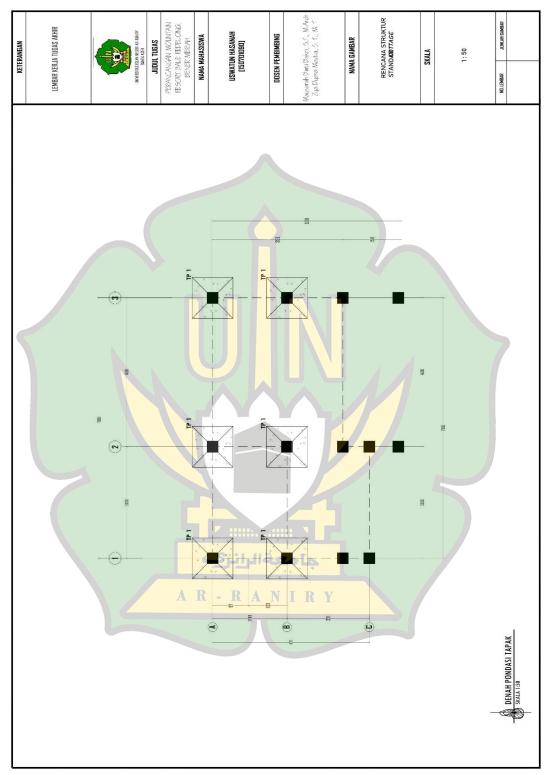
Rencana Pondasi Tapak Superior Cottage Sumber : Rancangan Pribadi
